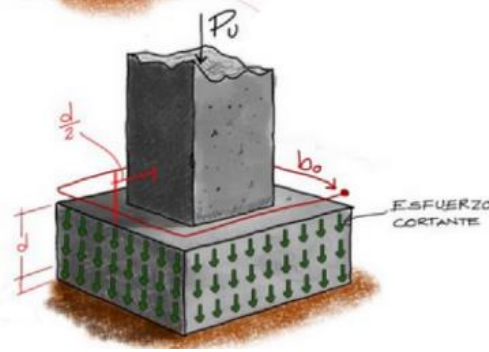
Sección crítica para corte por punzonamiento. (Pardo, s.f.)
